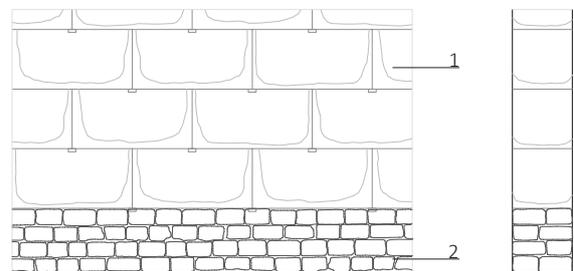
Detalle muro de tapia con breccas Fuente: propia
